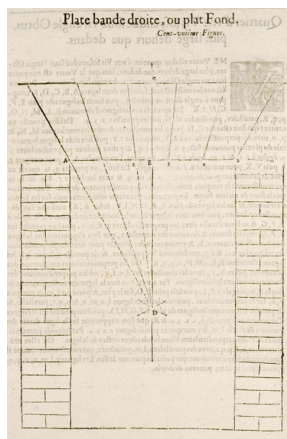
« Plate bande droite, ou plat Fond », d'après Jousse (1642, p. 202)
